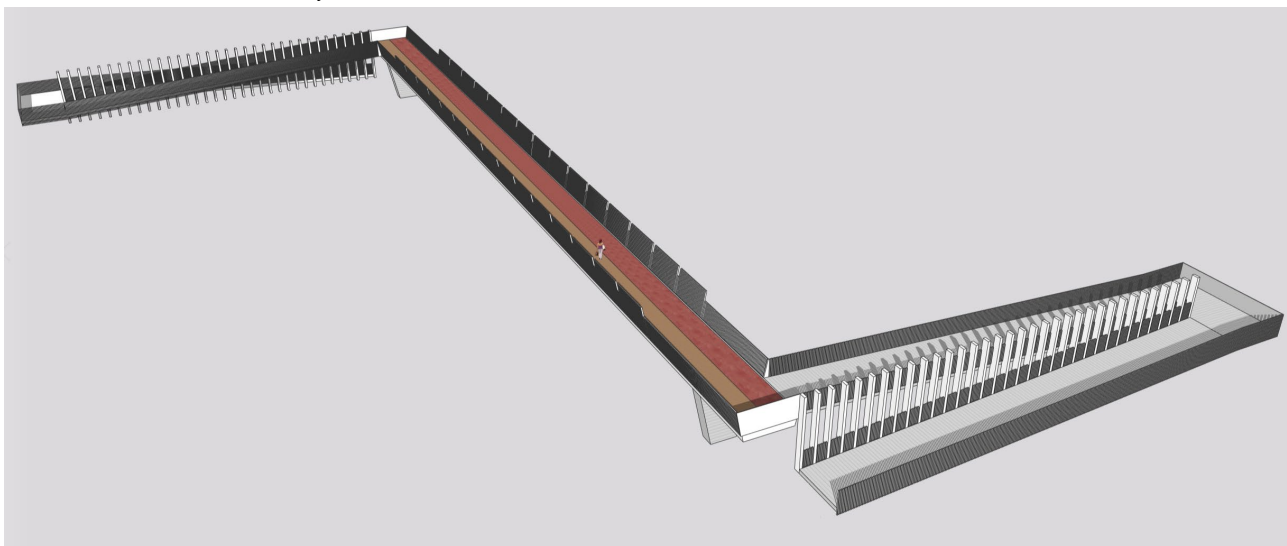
Fotomontaje de la pasarela con rampas laterales de acceso.
